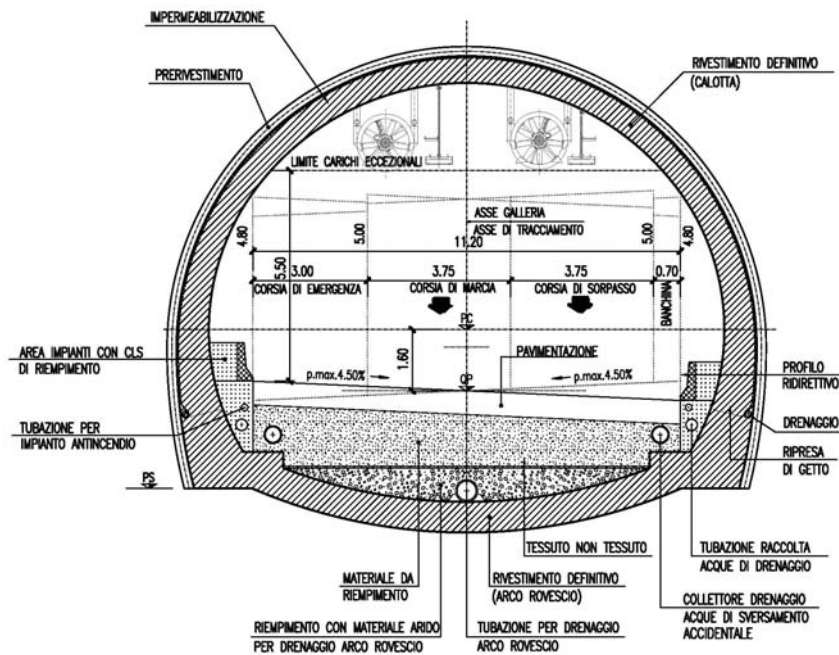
Sezione tipo in galleria naturale con scavo tradizionale
